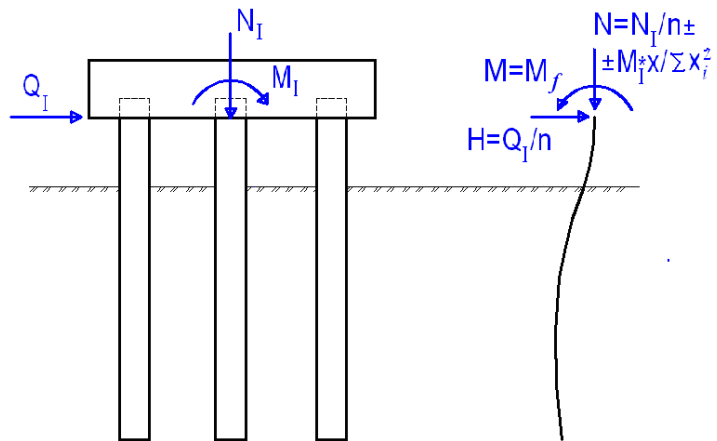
Определение нагрузок на голову сваи в случае жесткой заделки в ростверк и многорядном расположении свай (n – количество свай в кусте)
